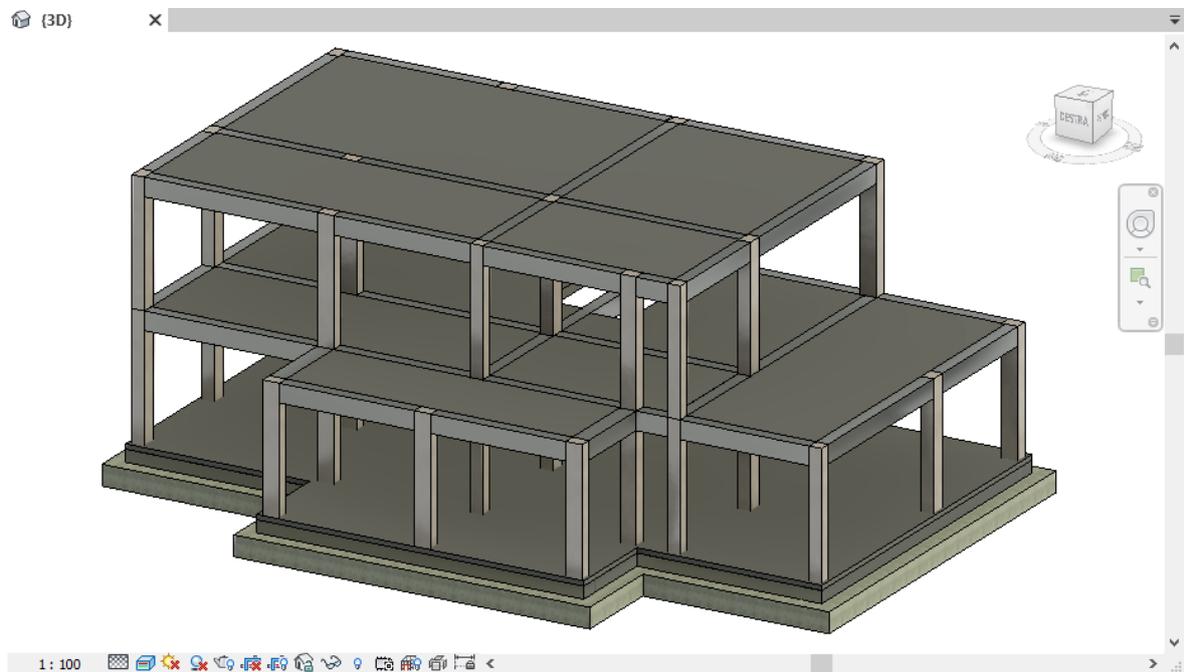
Vista tridimensionale (3D): Modello strutturale
